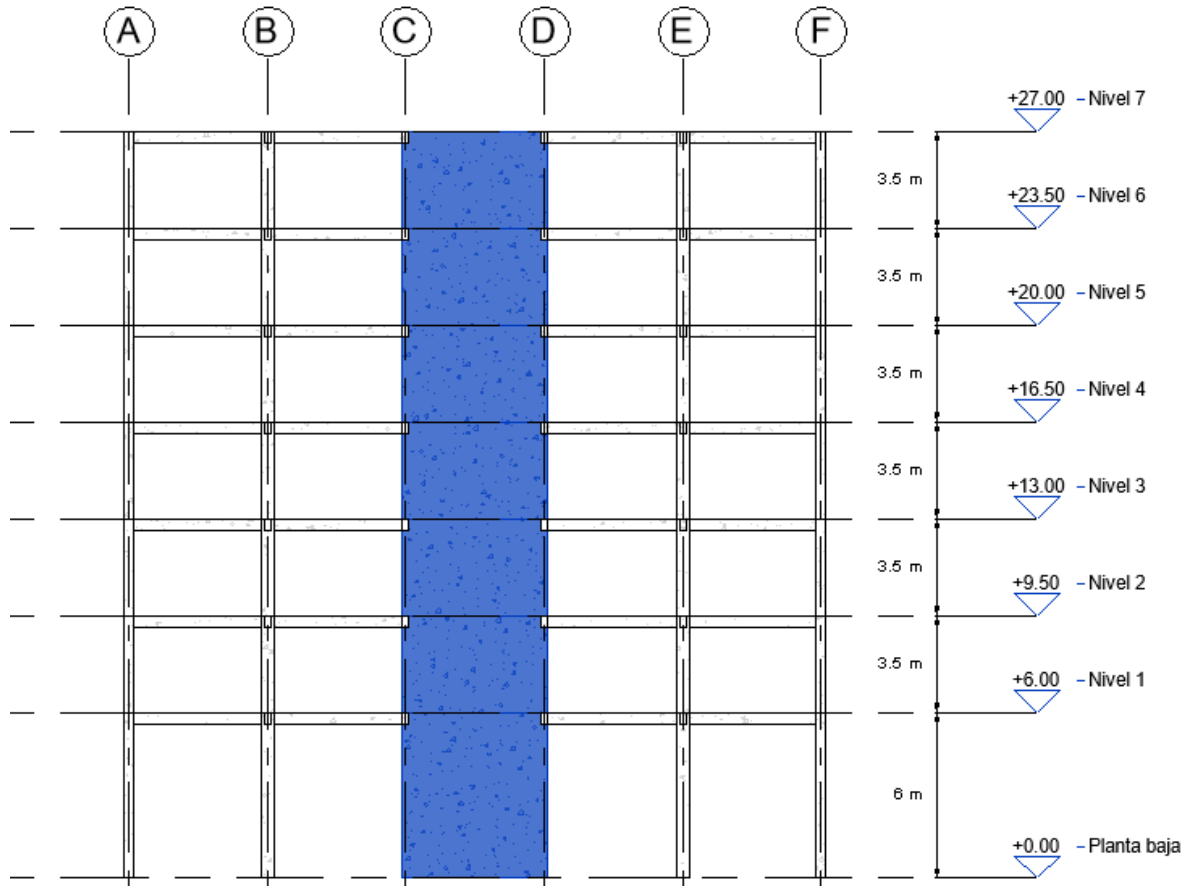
Muro de diseño. Fuente: elaboración propia.
